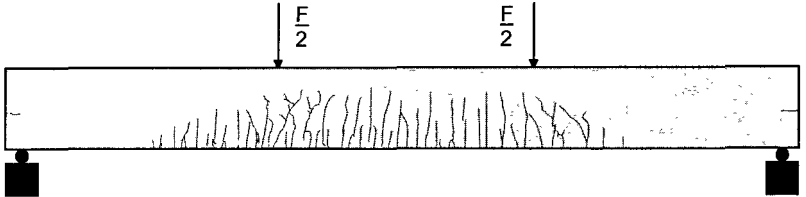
Rissbild Balken G06 nach dem Biegeversuch im Gebrauchslastbereich
